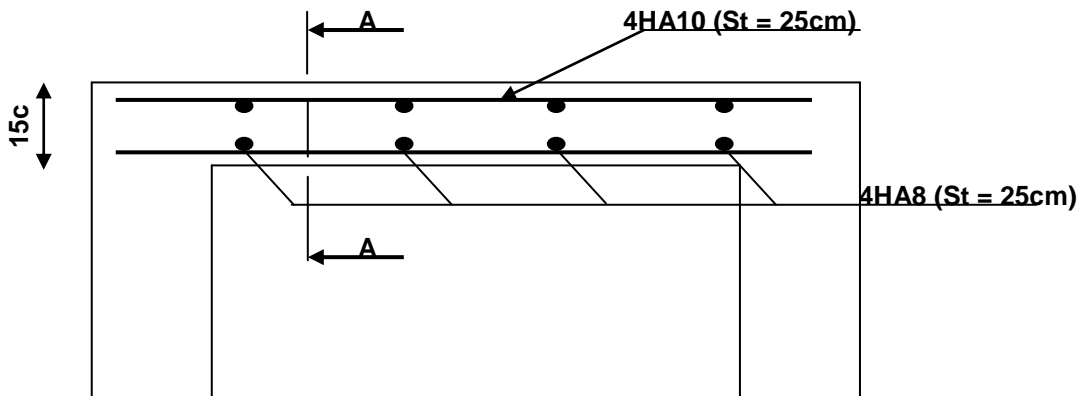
Plan de ferraillage de la dalle de la salle machine.
